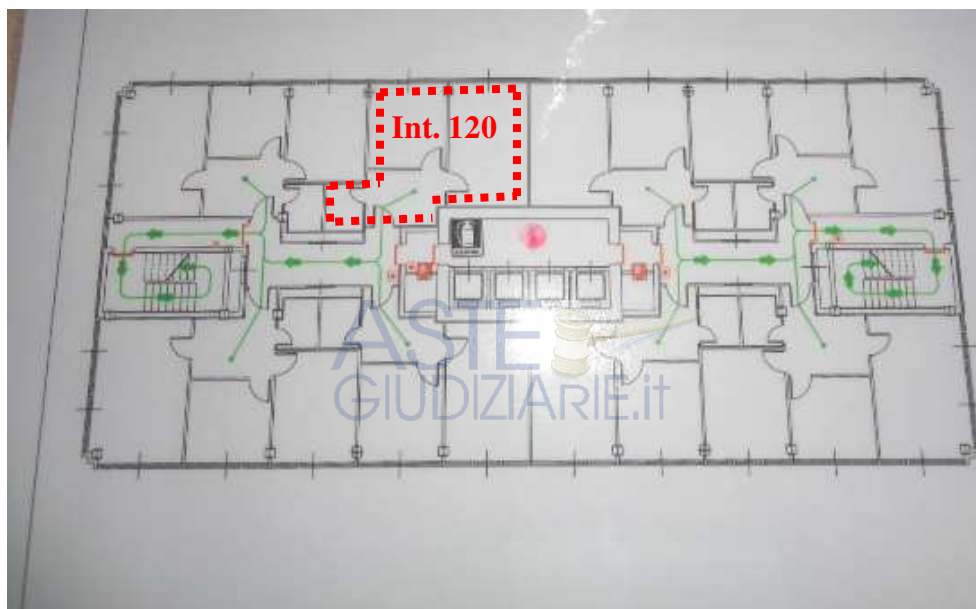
Schema 15° piano e individuazione dell'immobile d'interesse
